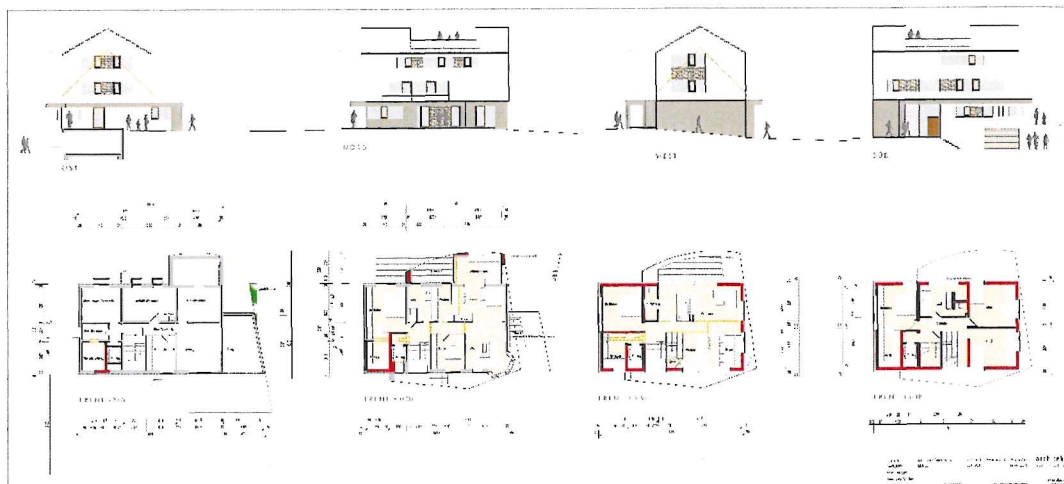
Neuhausstraße 4 – Grundrisse und Ansichten, 30.04.2021, Architekt Patrick Saffrin
